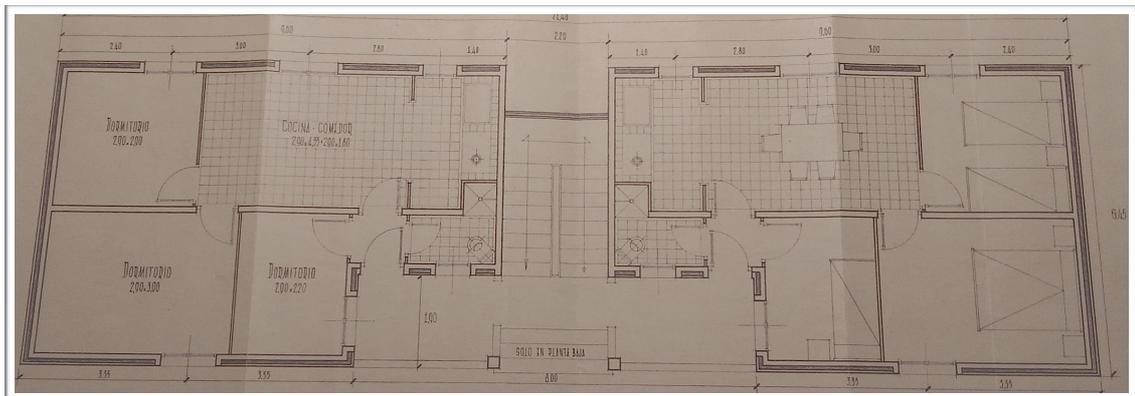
Plano de planta de las viviendas 1958 (Fuente: AMVG 45/33/9)
